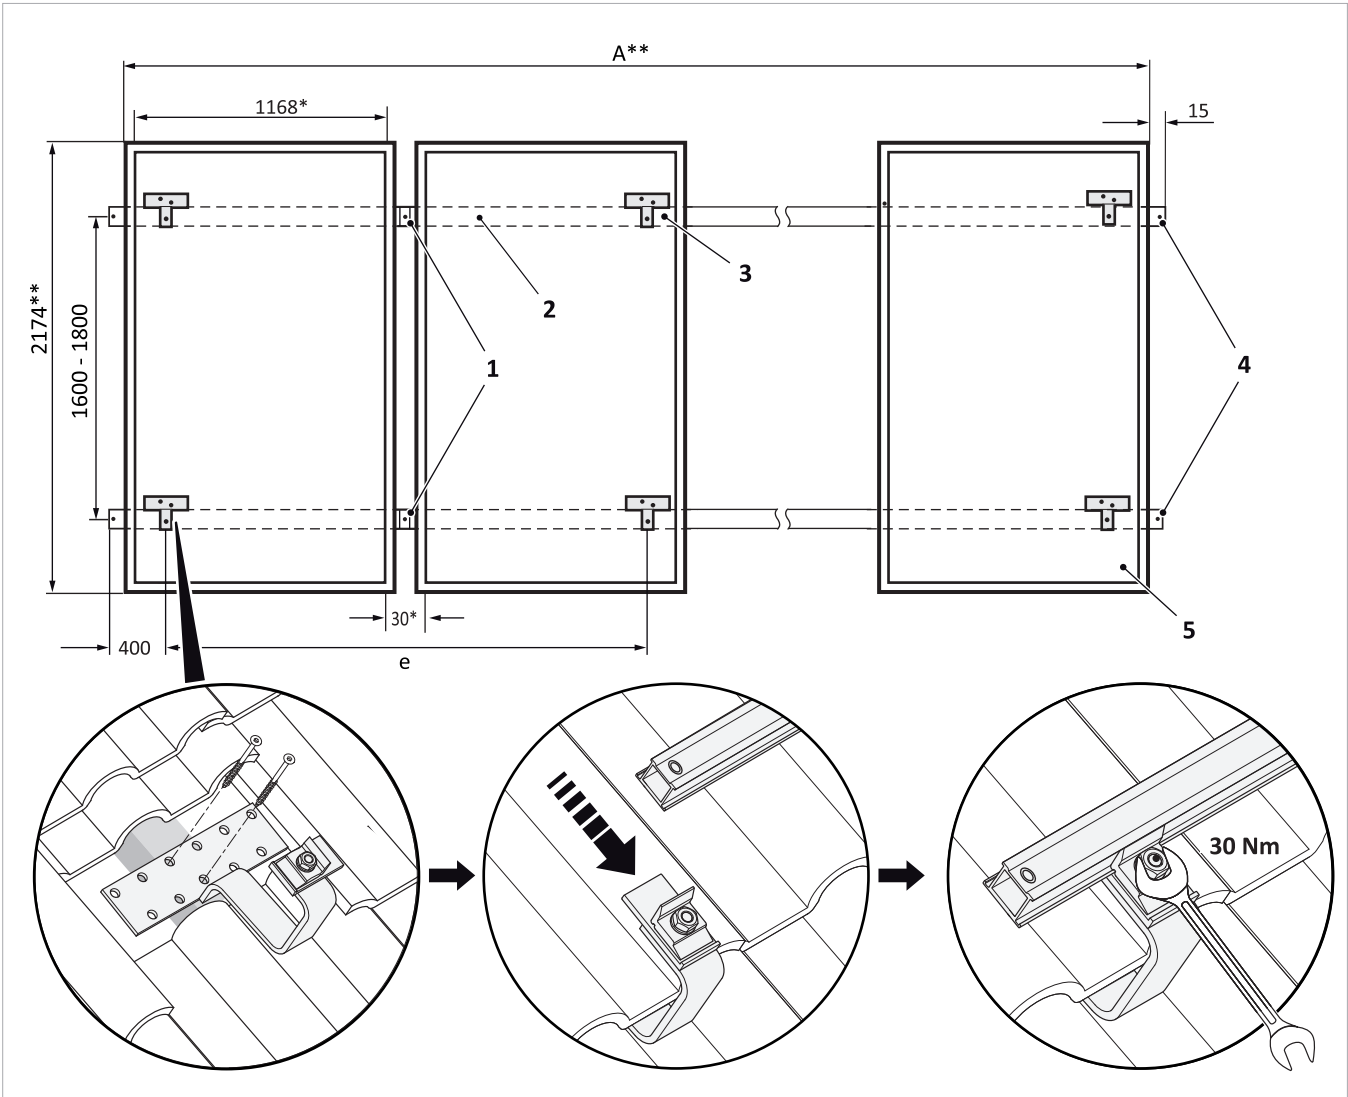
montage juxtaposé des fixations sur toiture et des rails de montage.
